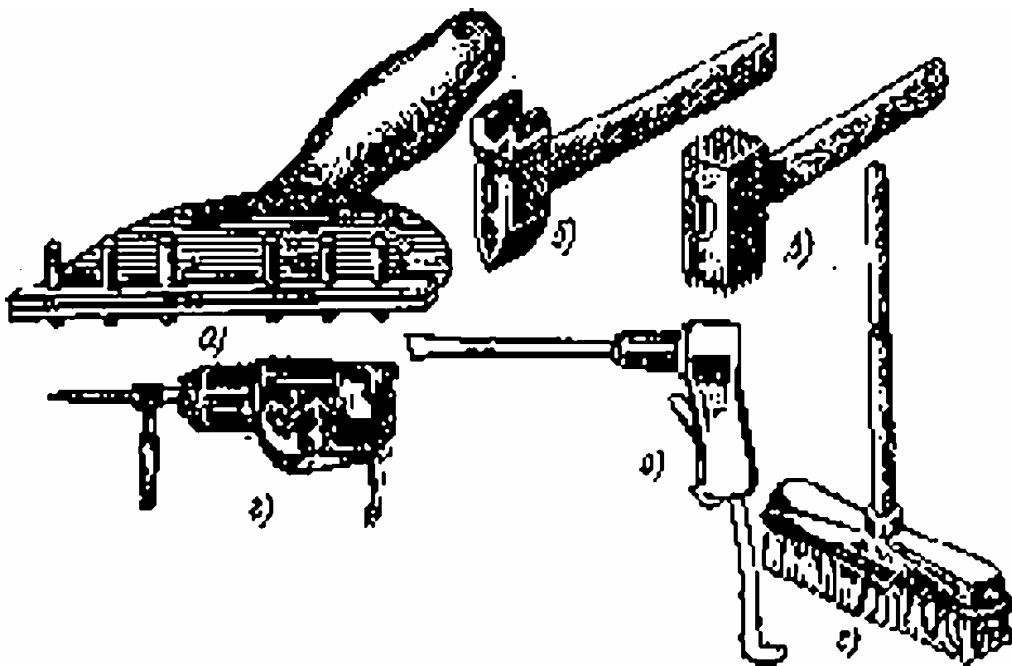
Інструменти і ручні манини для підготовки поверхонь під штукатурну ізоляцію:
